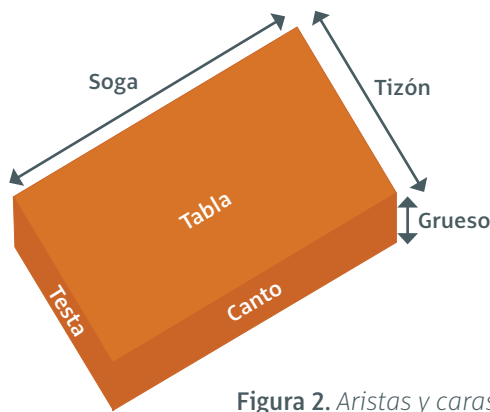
Aristas y caras de las piezas de fábrica de albañilería
